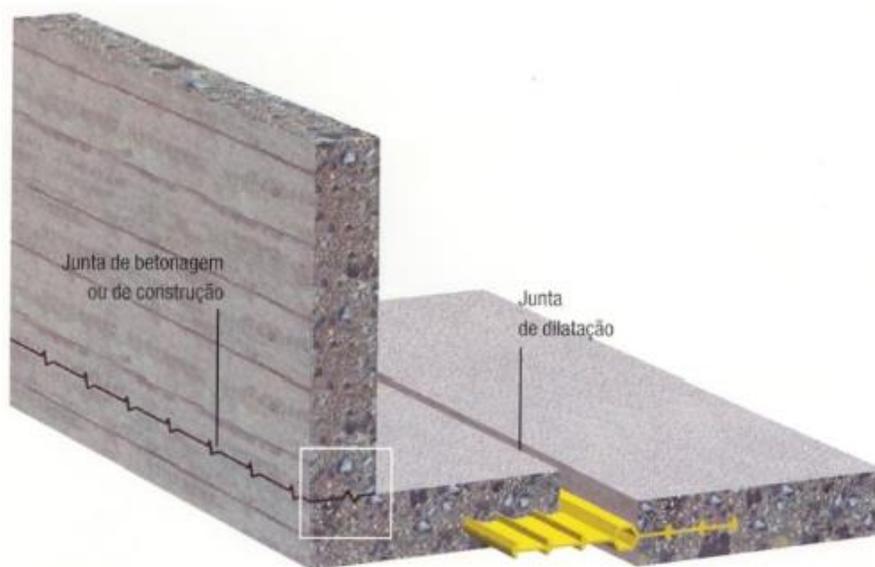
Juntas de betonagem e dilatação (Pereira 2010)
